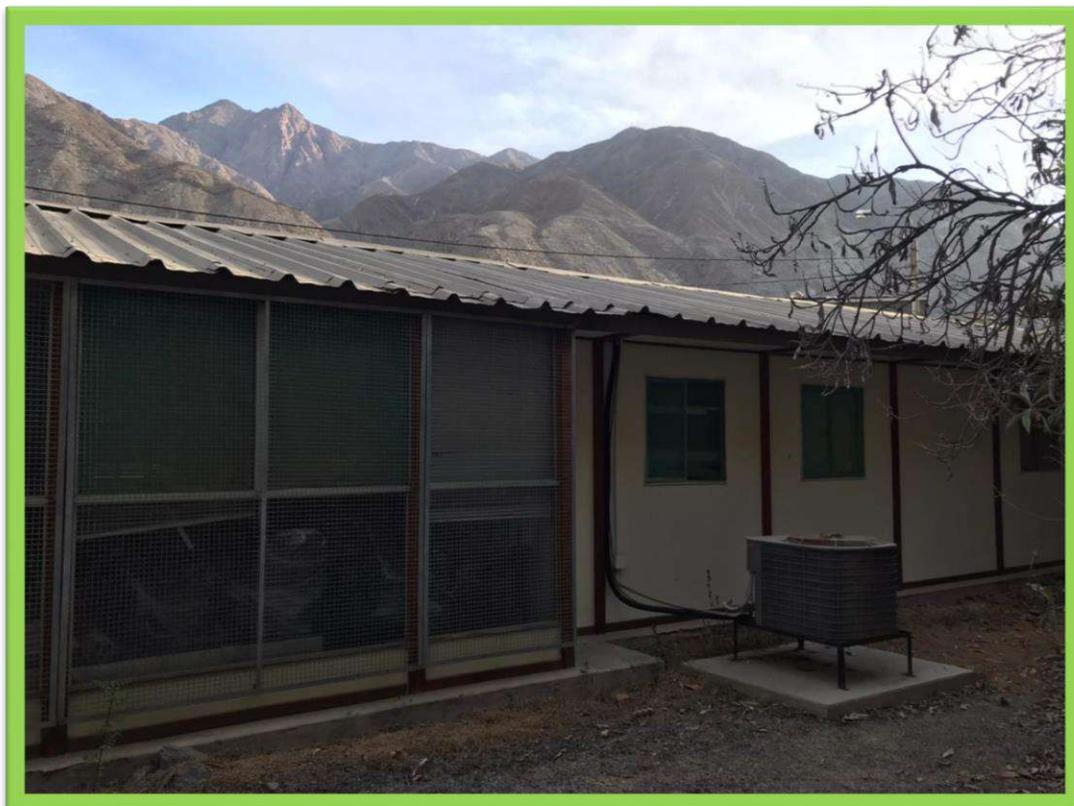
Distribución de ambientes con tabiquería con paneles DMF
